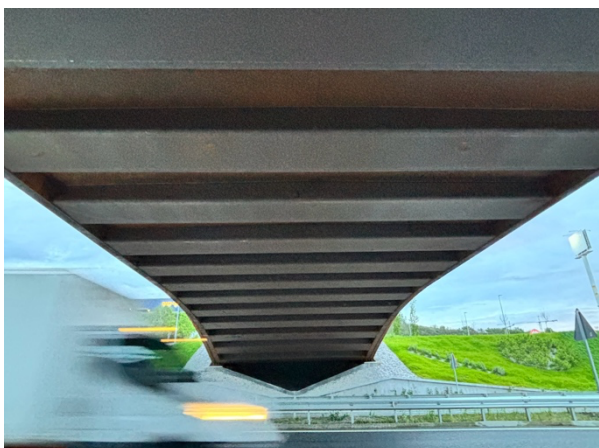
Viguetas transversales en "U" y muro en diente de sierra.
